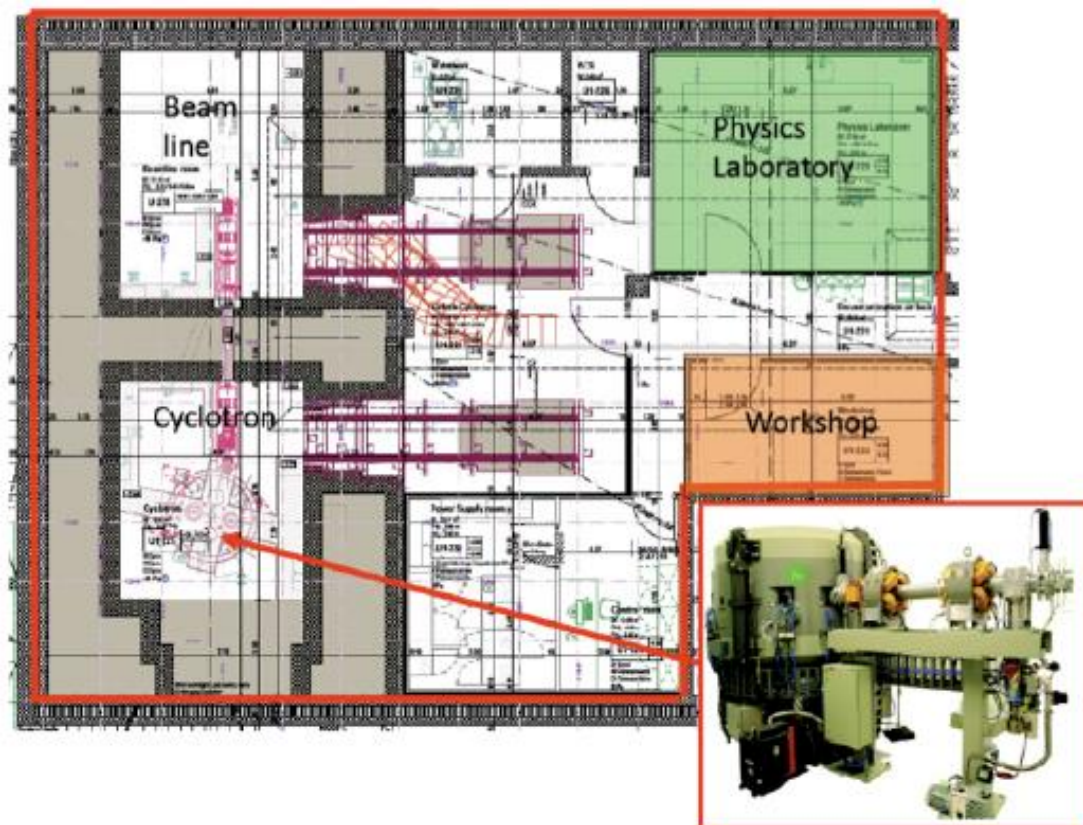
Planta da nova instalação do CERN-MEDICIS.
